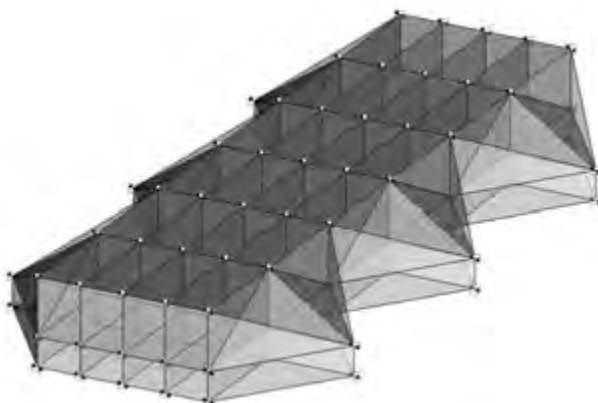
Конструктивная схема фундаментного блока-подушки для расчета в ПК Structure CAD
